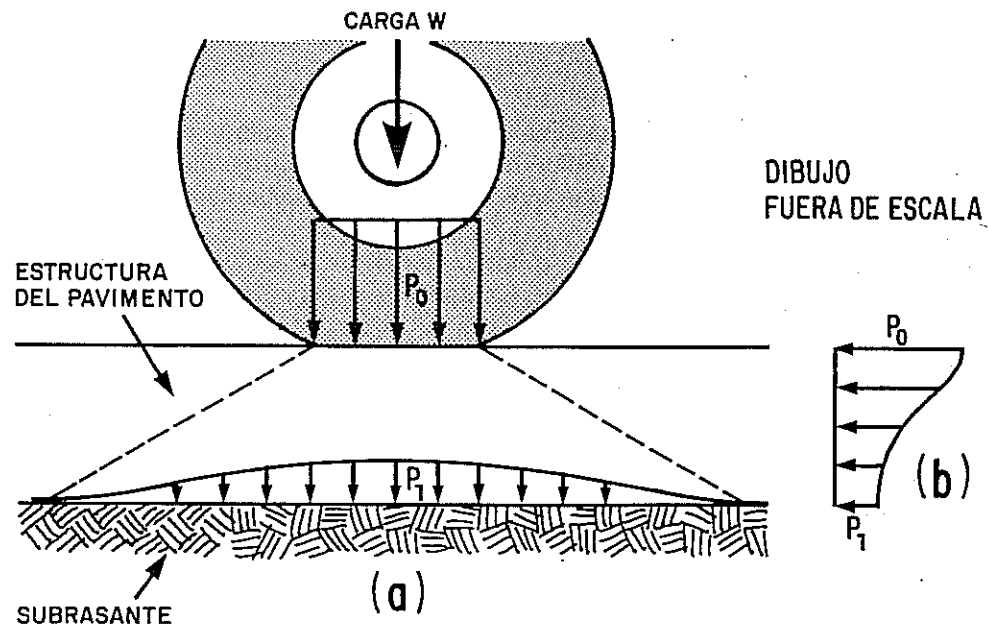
Distribución de la carga de la rueda a través de la estructura del pavimento.
